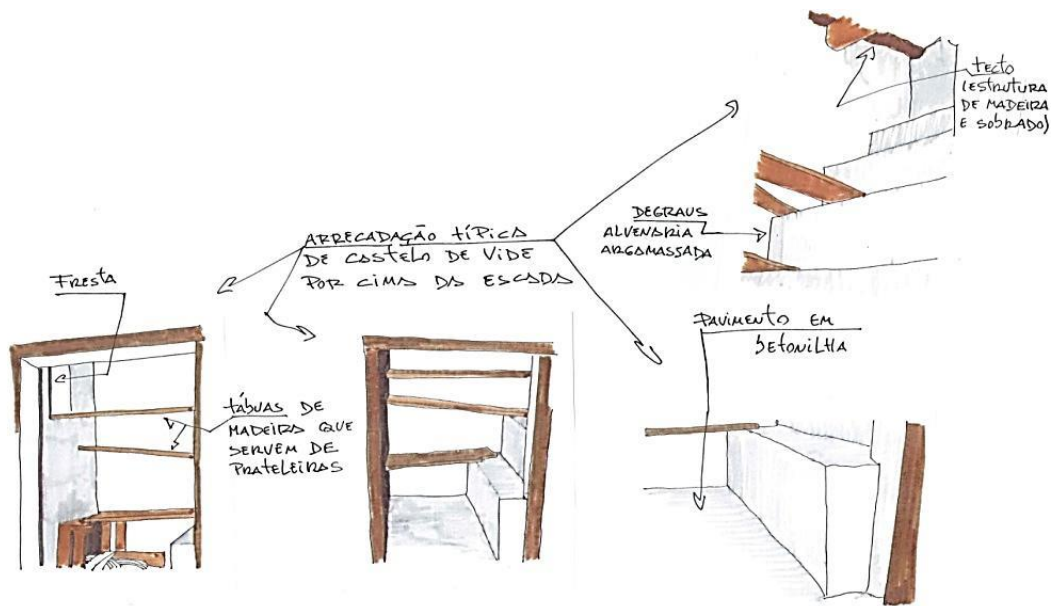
Vistas do existente (interior) – despensa sobre a escada
